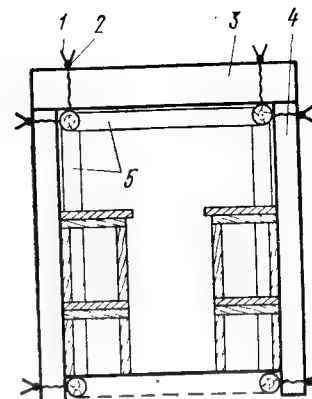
Поперечный разрез убежища, возводимого с использованием для устройства стен железобетонных плит, устанавливаемых на ребро
